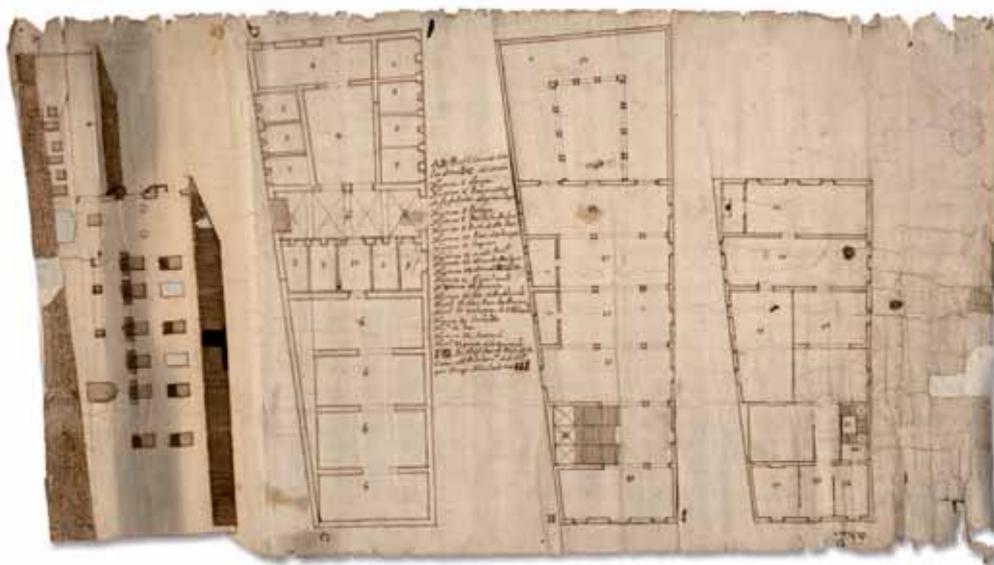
Casa Consistorial de Pamplona. Plantas de sótano, baja y primera; y alzado fachada lateral. Anónimo. c. 1751 (Archivo Municipal de Pamplona).
